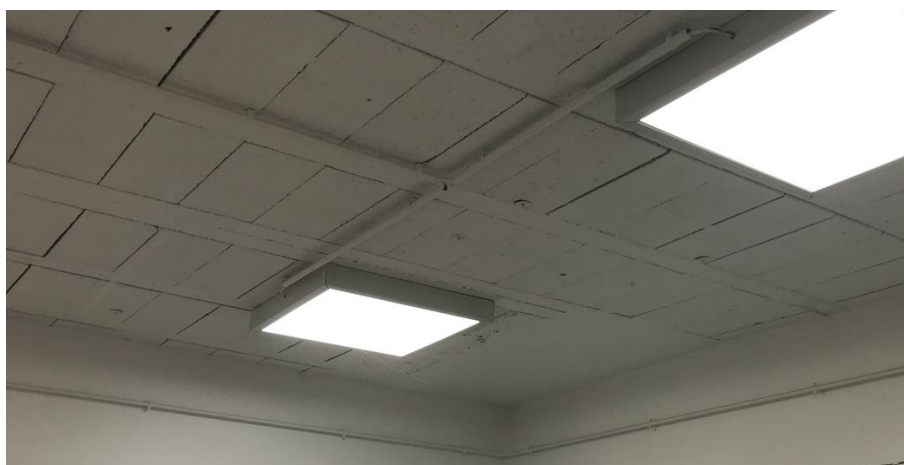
Plancher poutrelles & hourdis (local N.O.34-A)
